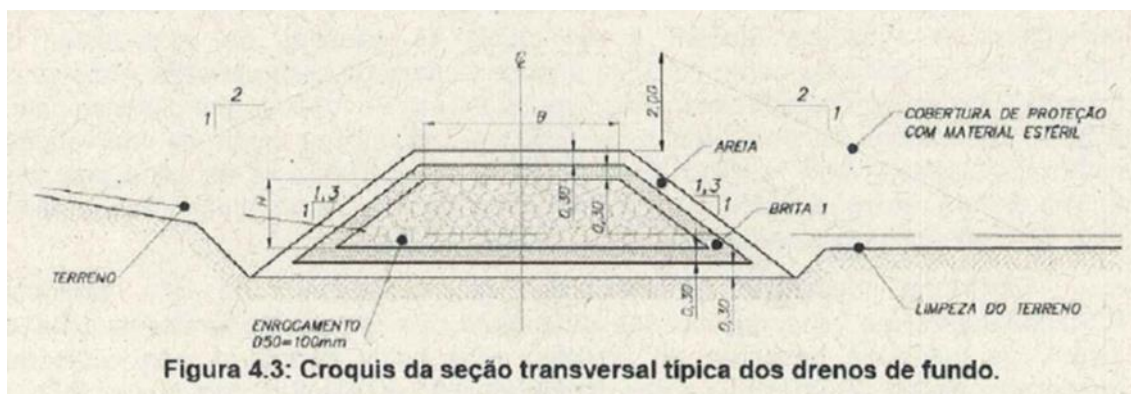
Croquis da seção transversal típica dos drenos de fundo.
